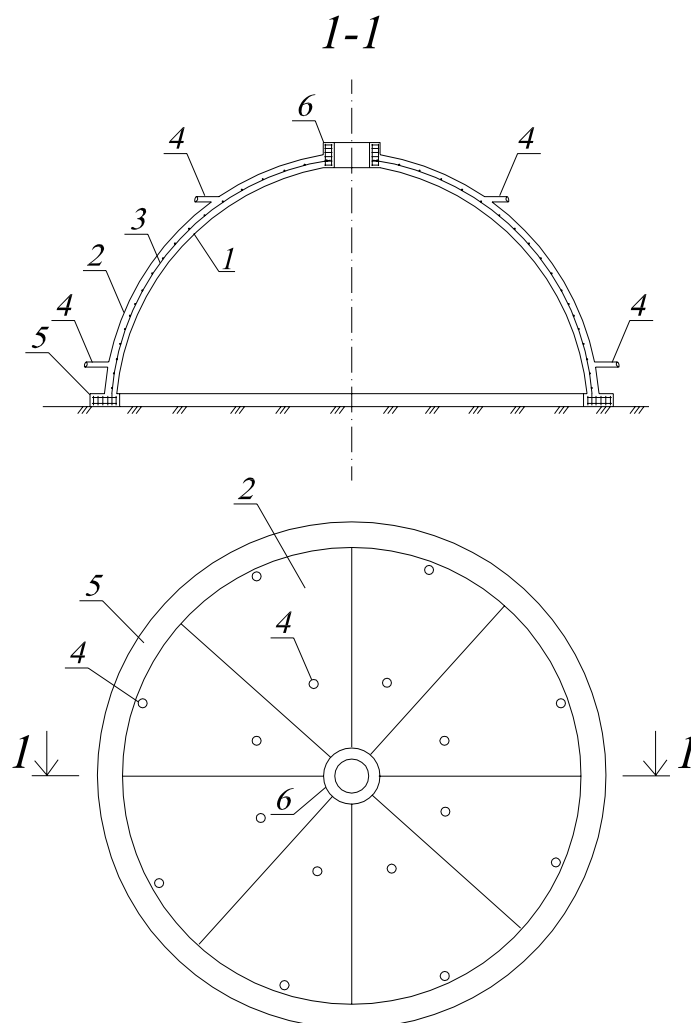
Монтаж опалубки купола: 1 – внутренняя опалубка; 2 – наружная опалубка; 3 – арматура купола; 4 – штуцеры для подачи бетона; 5 – нижнее опорное кольцо; 6 – верхнее опорное кольцо.
